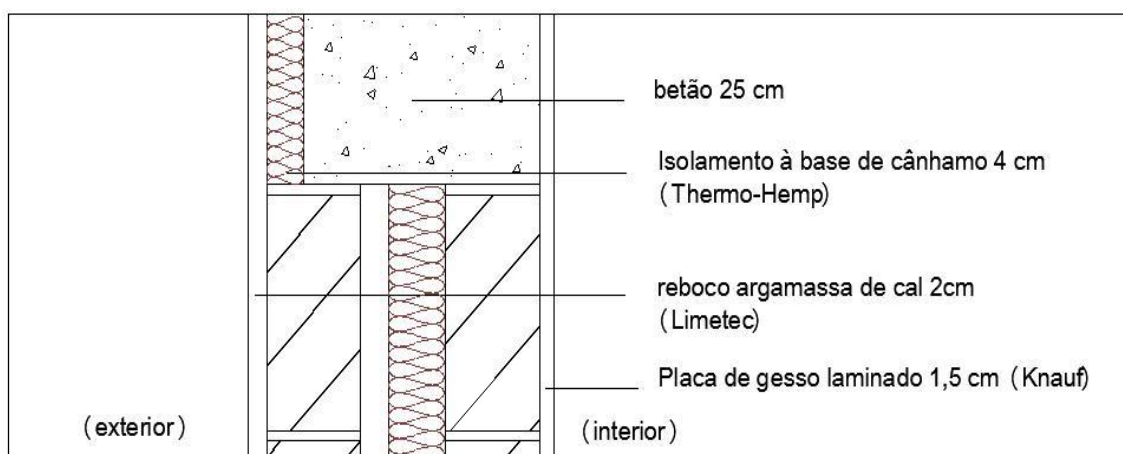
Pormenor construtivo de zona ponte térmica plana (pilar ou talão de viga) proposta na solução 1
